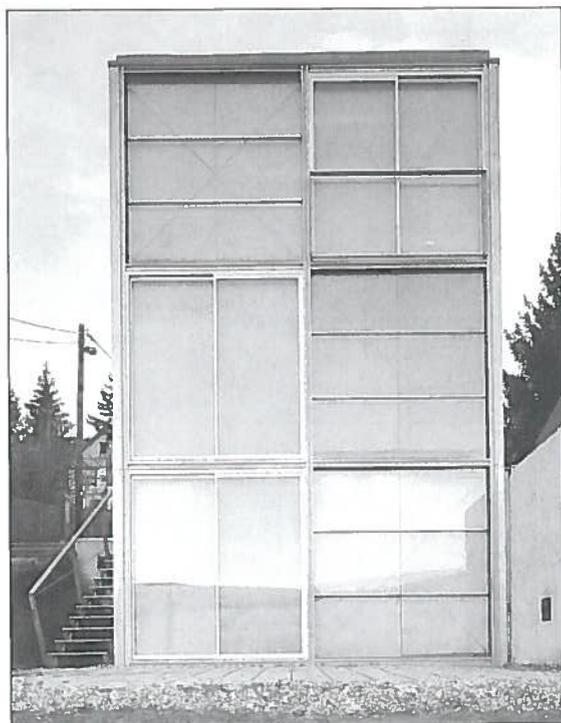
Vista del fronte nord dell'edificio: la Teehaus è caratterizzata dalla modularità, che deriva dalle campate della struttura portante a vista e dalle campiture formate dagli elementi di involucro.
